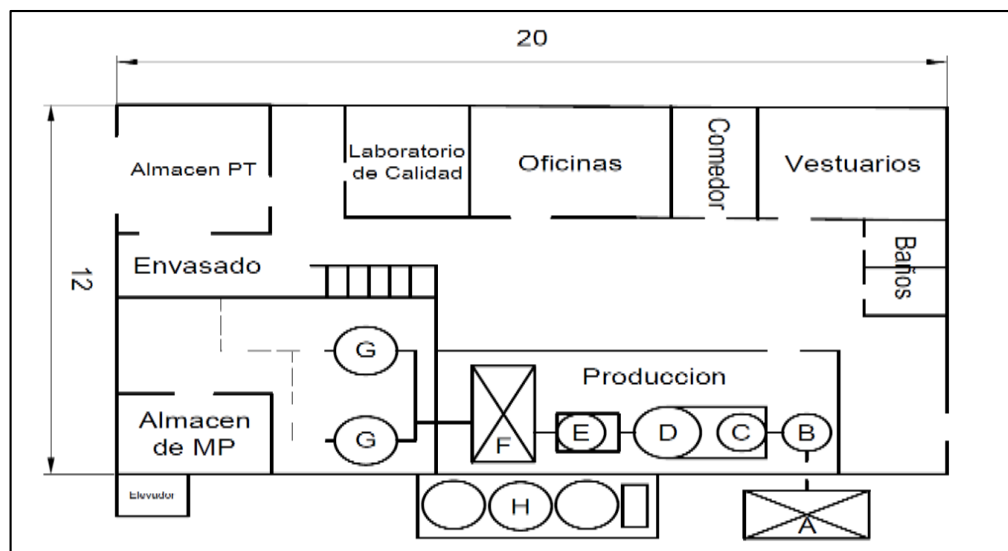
Diseño sanitario de una Planta de lácteos
